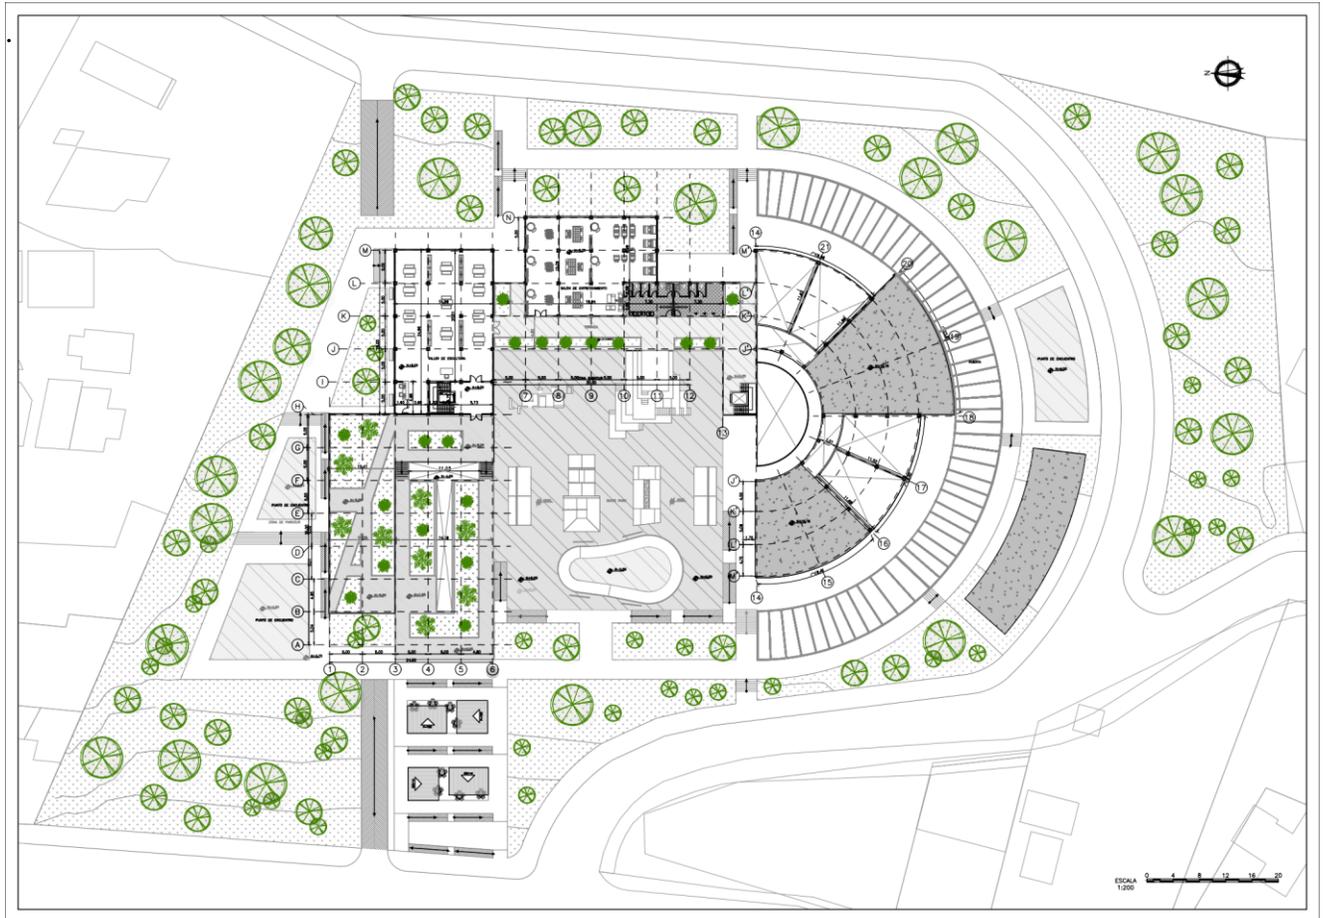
Desarrollo arquitectónico planta tipo 2 y 3. Fuente: Elaboración propia.
